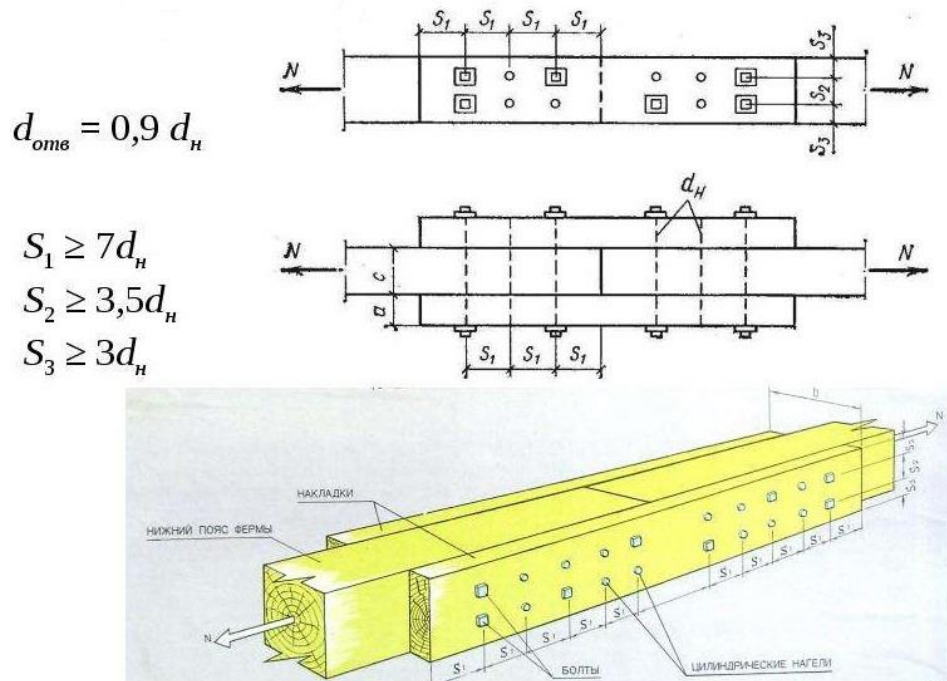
Пример растянутого стыка нижнего пояса деревянной фермы, выполненного на стальных цилиндрических нагелях
